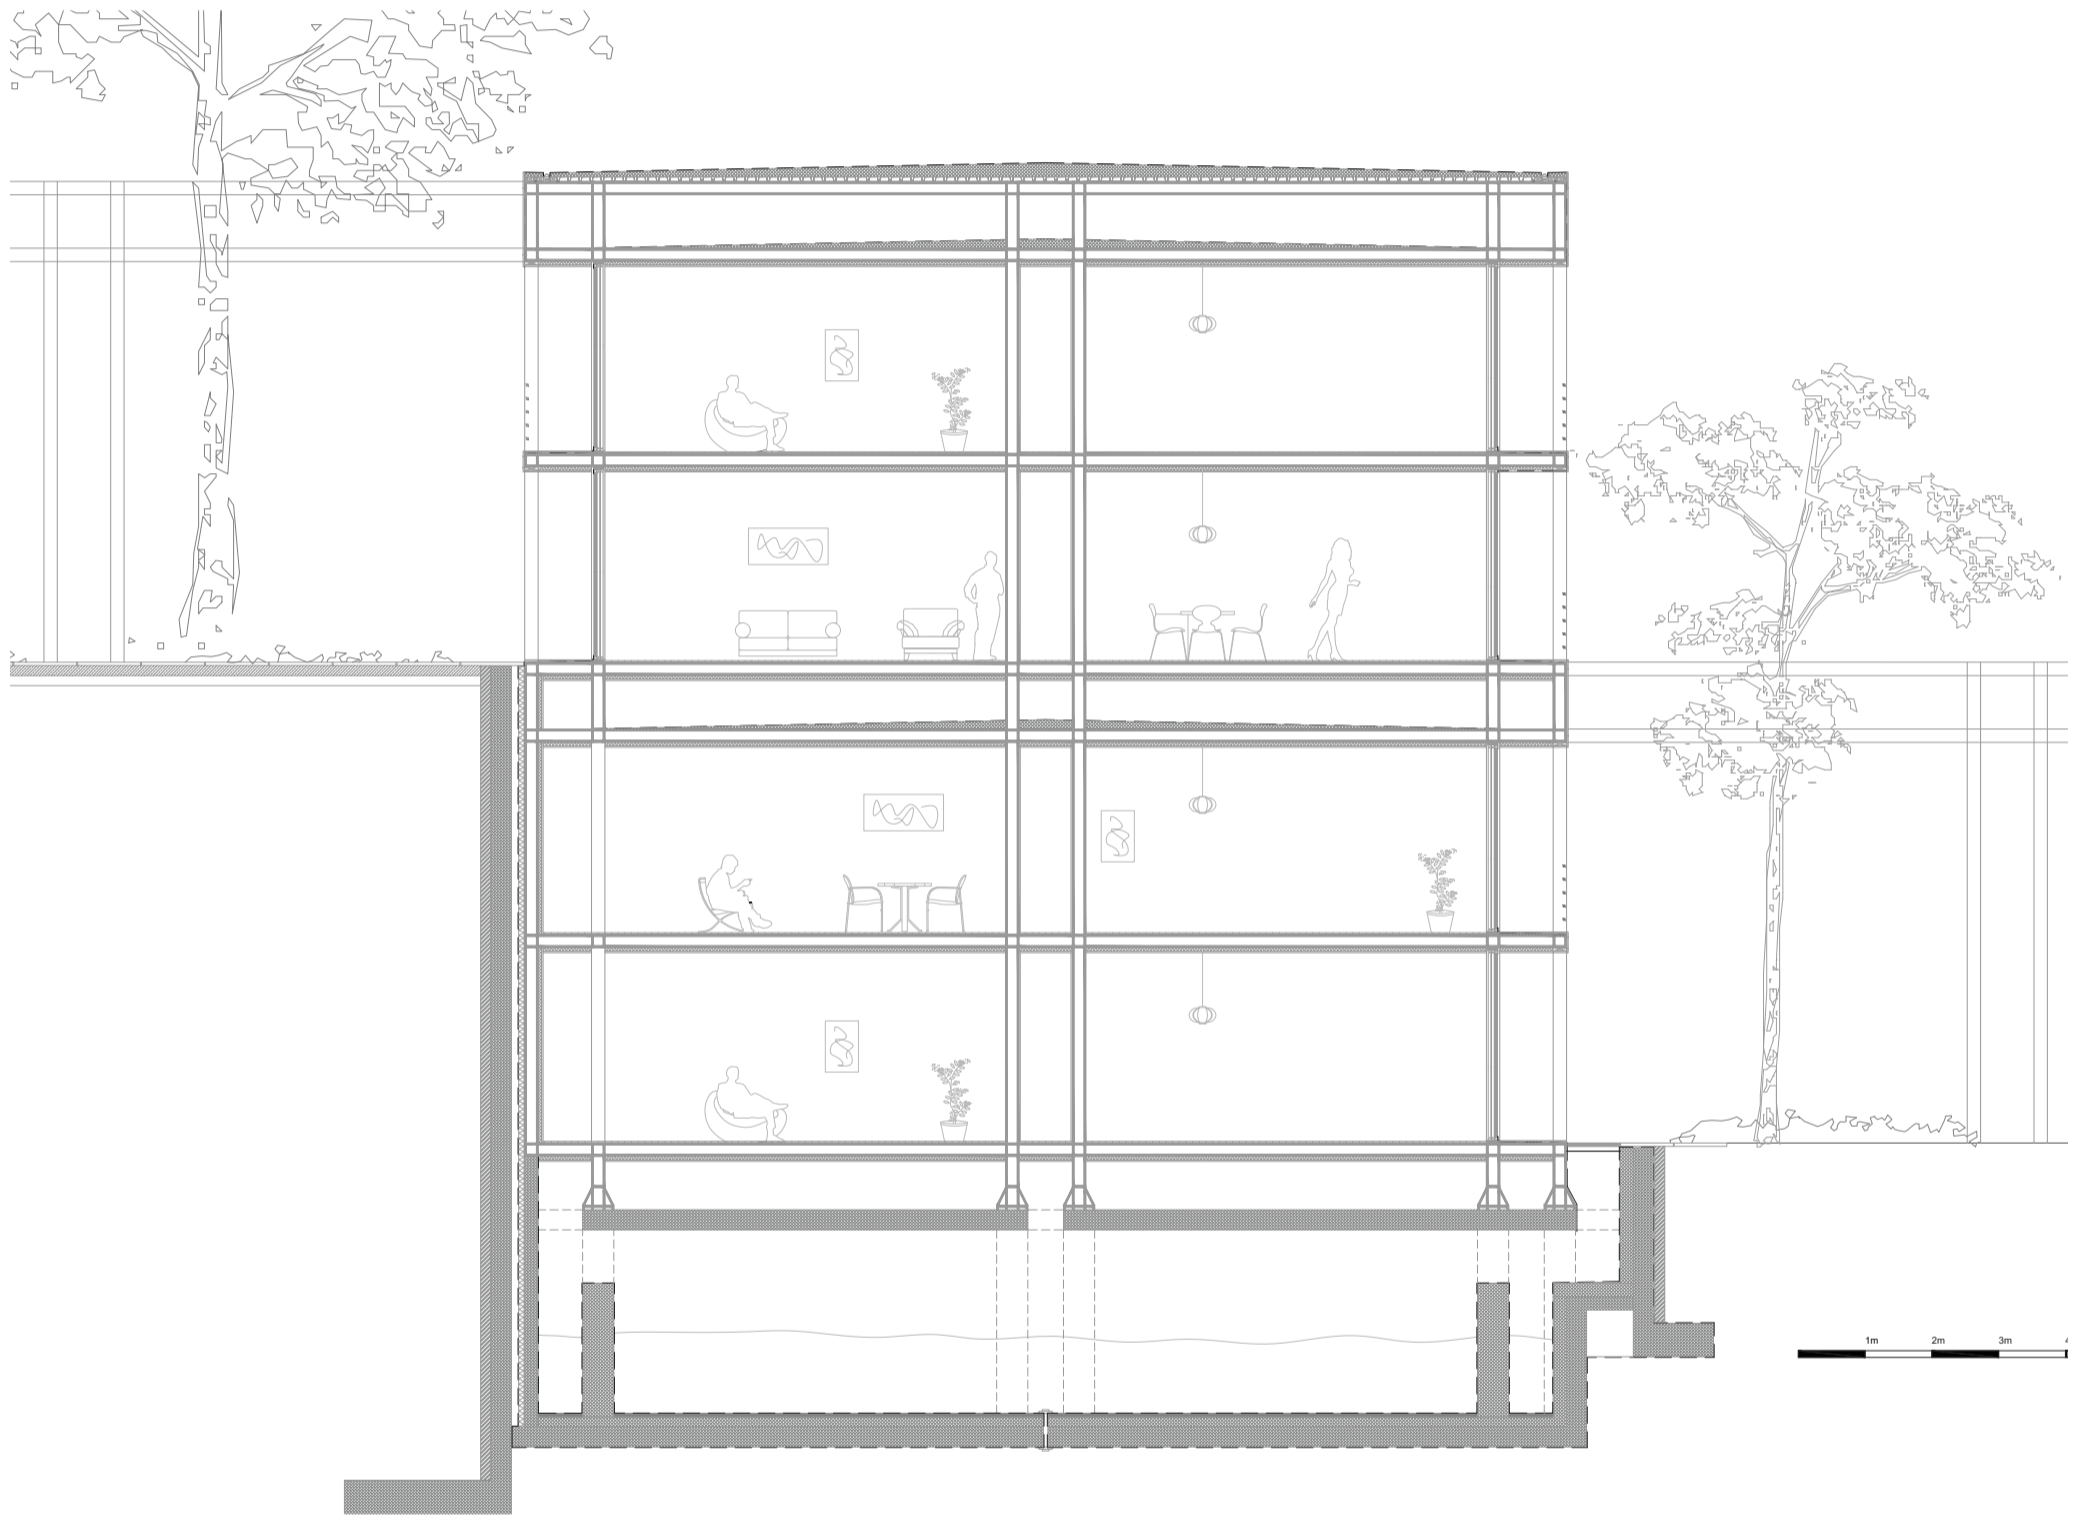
corte detalhado edificio modular (desenho do autor)
